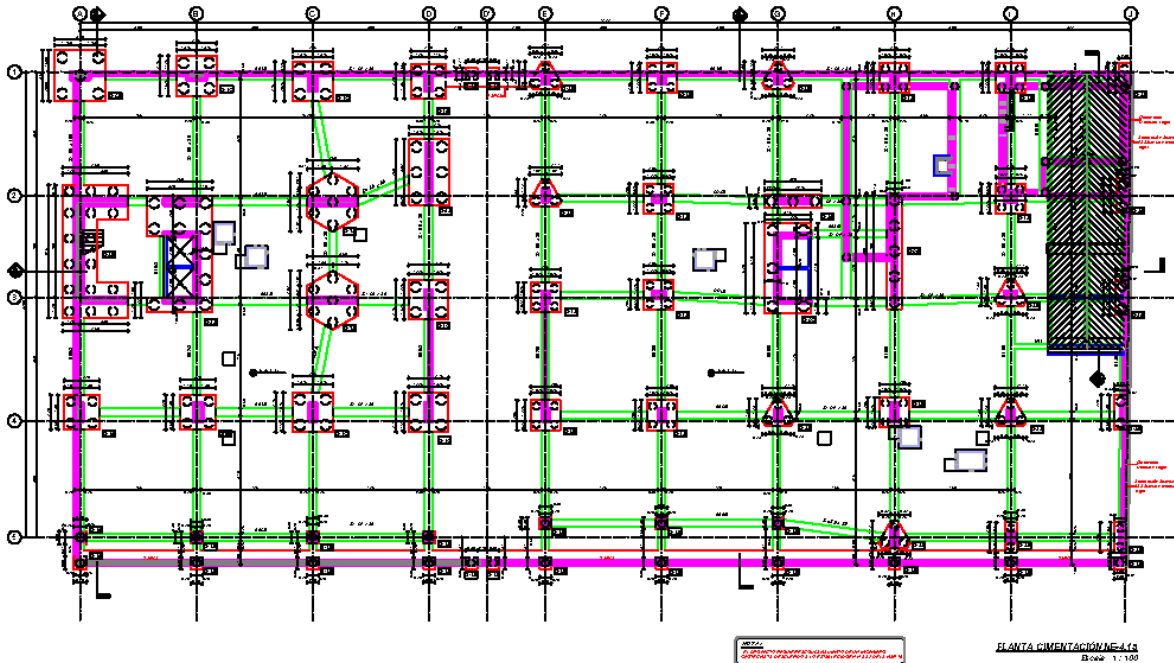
Plano arquitectónico fiscalía general de la nación.
